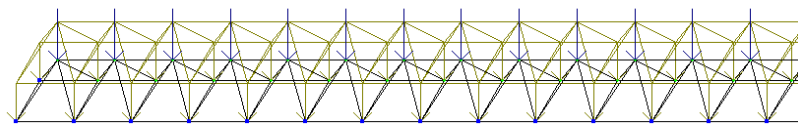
Фрагмент ферми з діючим навантаженням.
